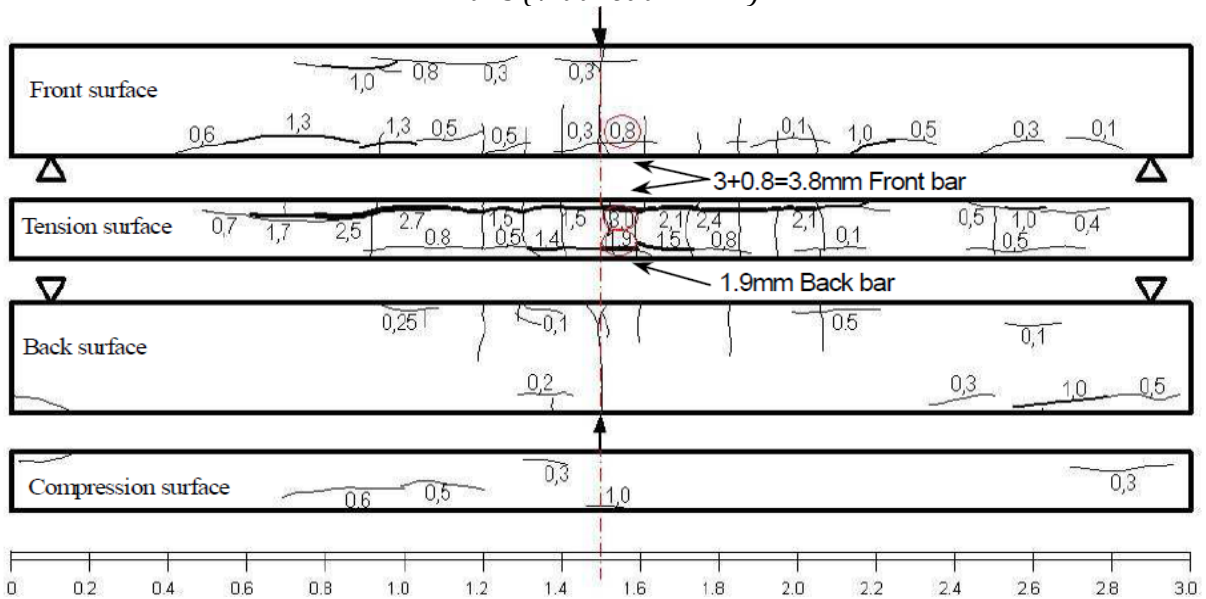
Carte de fissuration de la poutre B2CL1 avec les ouvertures des fissures de corrosion en mm après 19 ans (R. Zhang et al. 2009).
